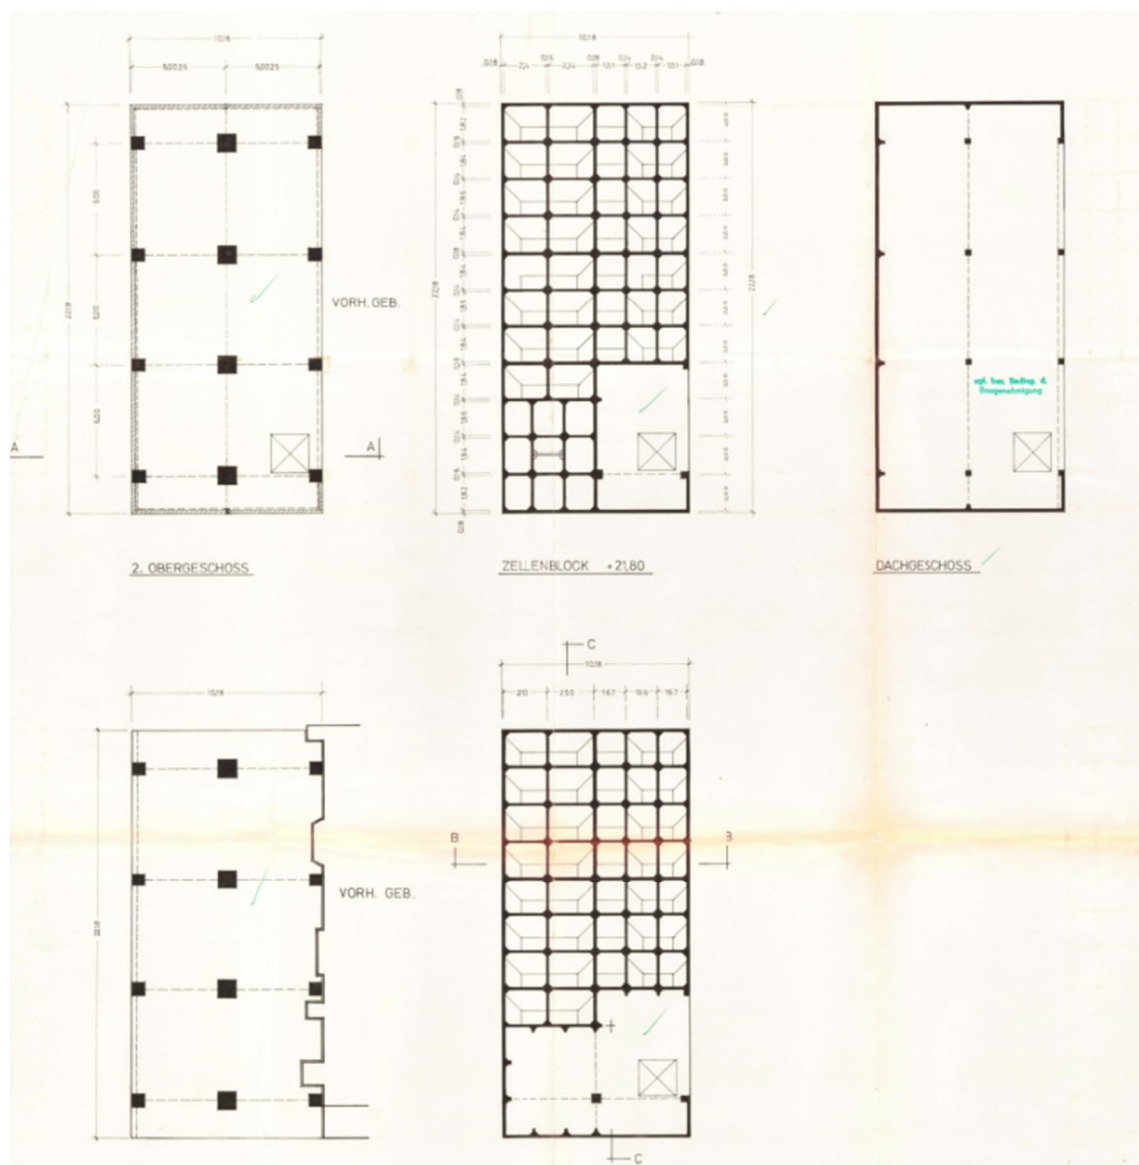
Grundrisse Bestandsgebäude B2
